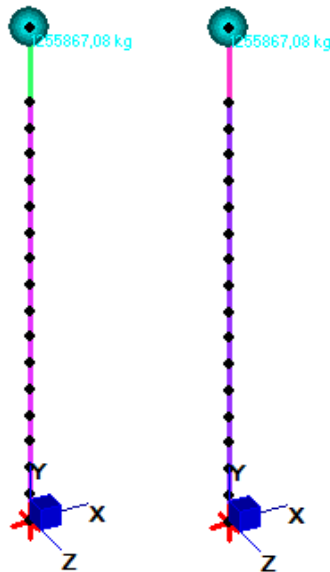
Modello pila 11.50m - Pila e pila fessurata
